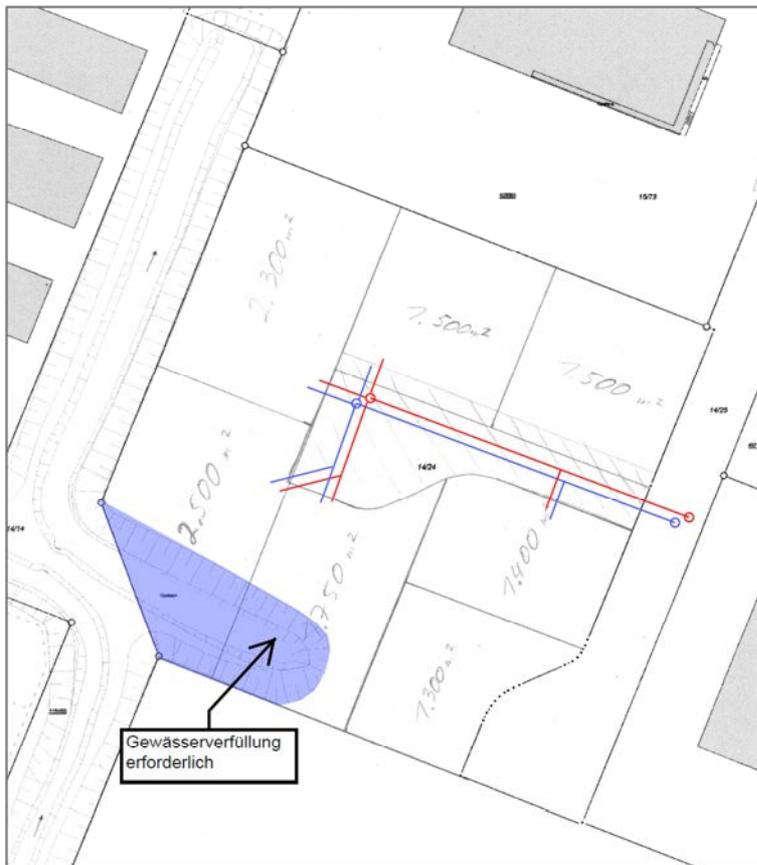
BIP - Darstellung einer Stichstraße und der sich hieraus ergebenden Flächenzuschnitte
